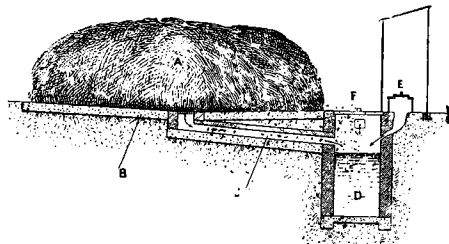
Platformă concavă cu groapă de urină, betonate. A - Bălegar; F - Groapă; E - Latrină; D - Urină
